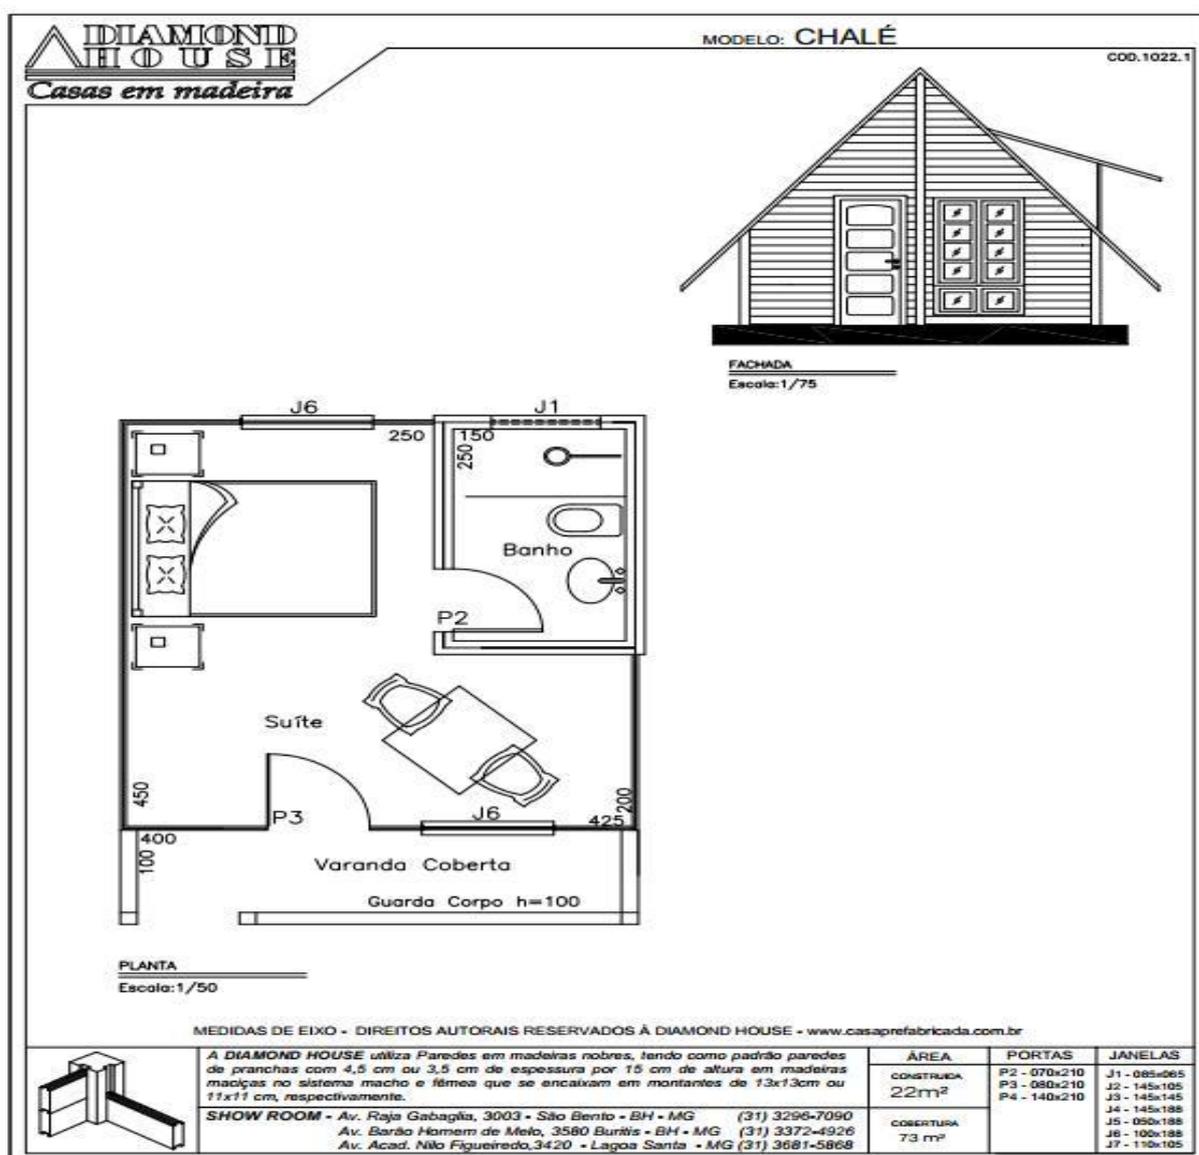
Desenho comercial de vendas com Planta e Fachada.
